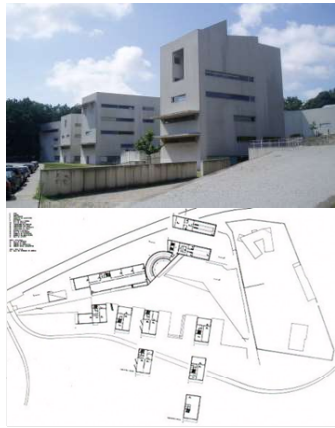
La Escuela de Arquitectura de Oporto. Acceso, vista exterior sur y planta general de la intervención. Oporto, 1985-1996, Alvaro Siza.
